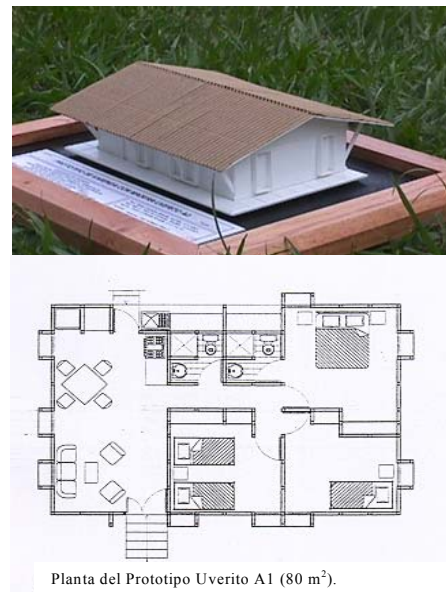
y 4. Vista y Distribución en Planta del Prototipo A1 Desarrollado por Contreras et al (2003).
